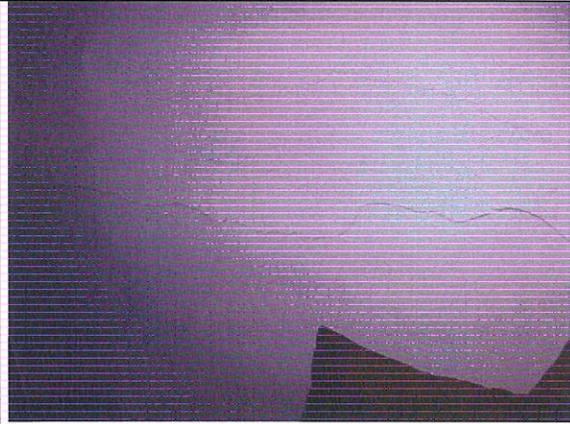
Grietas en muro culata suroriental, torre IV.
